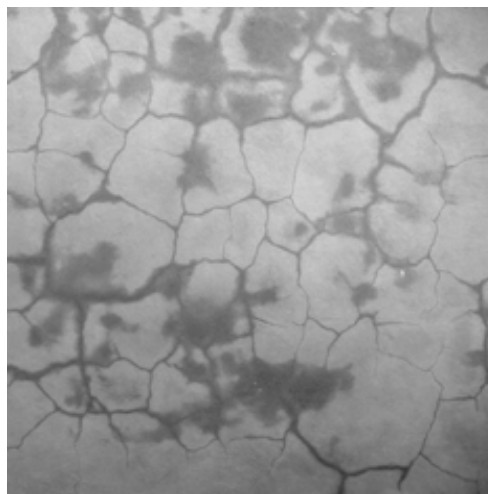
Fissuração decorrente de retração da argamassa (SILVA e ABRANTES, 2007).
